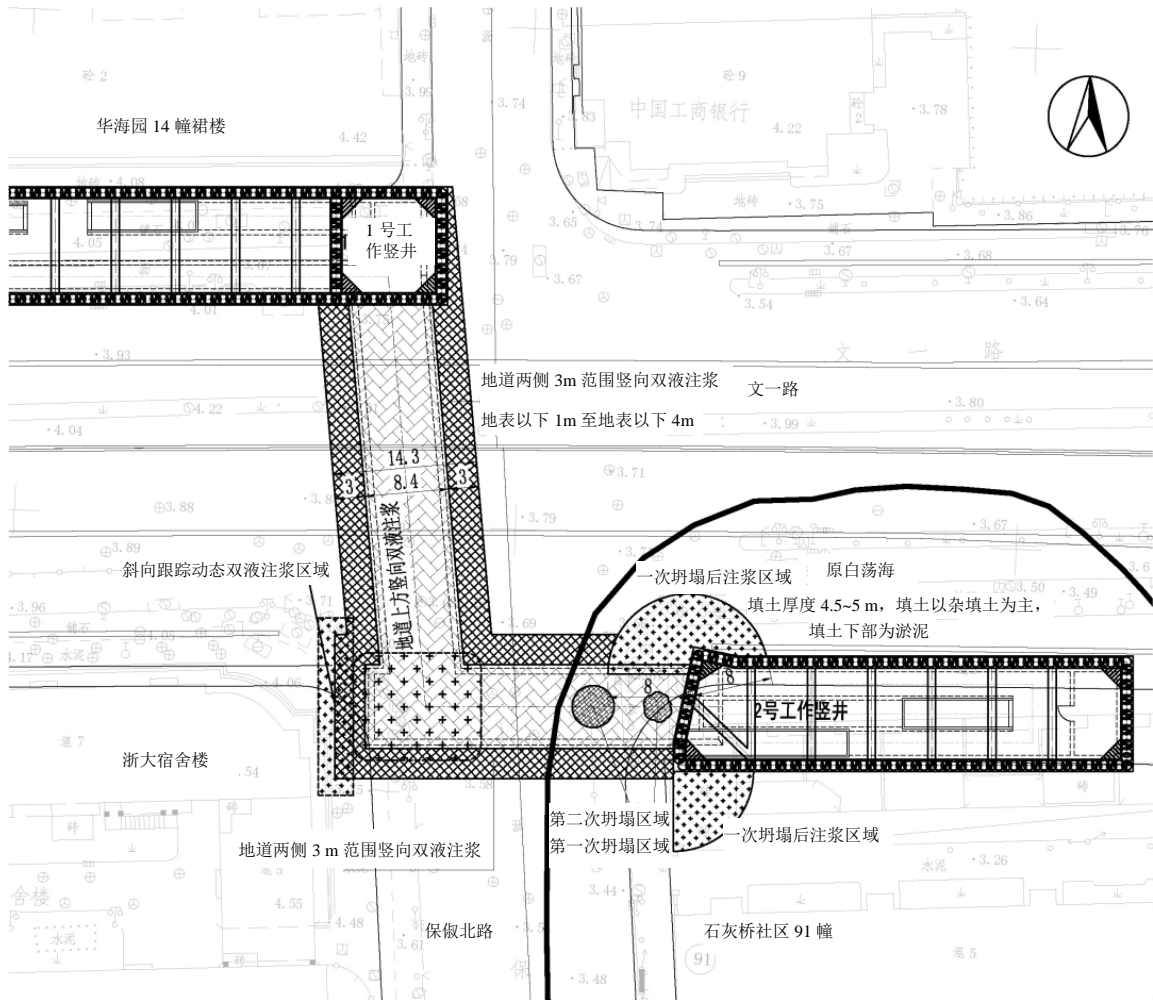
地道上方地表竖向双液注浆加固平面布置示意图
